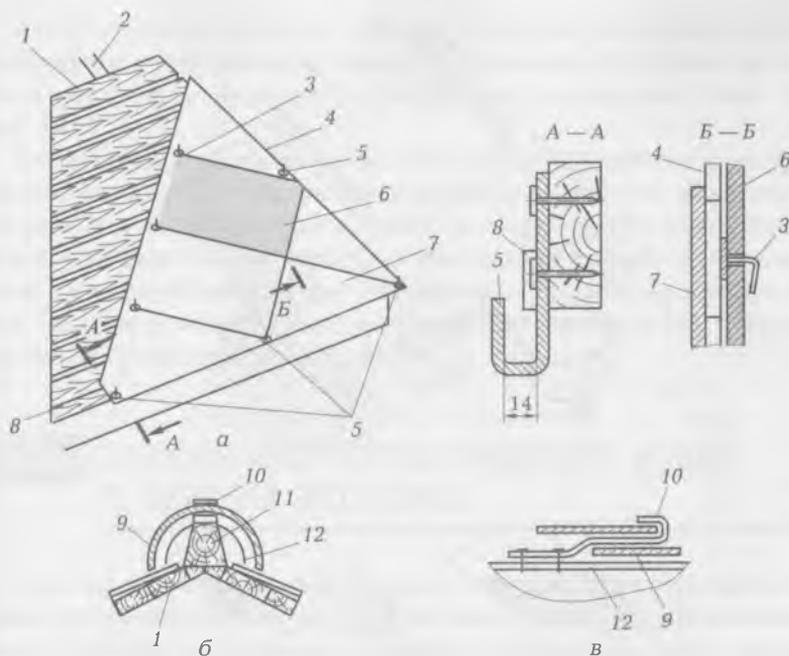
Кровля из асбоцементных плоских плиток:
